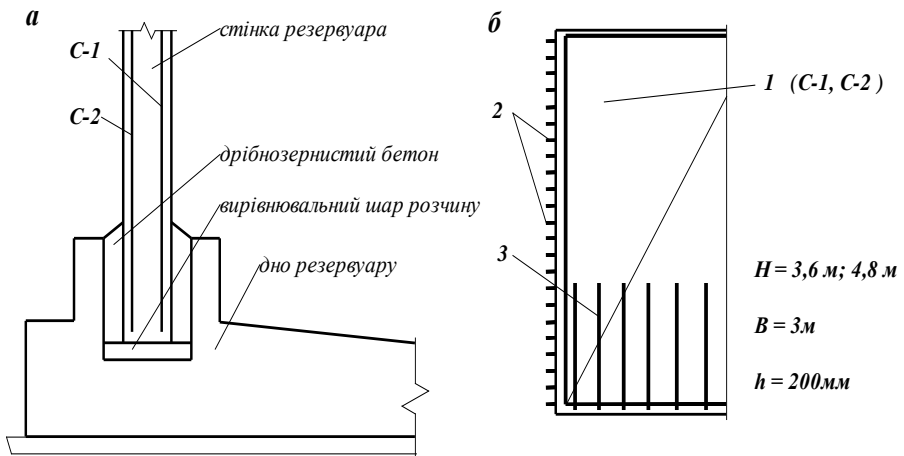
Конструктивні параметри та армування стінок монолітного (а) та збірного (б) резервуару, прямокутного у плані
